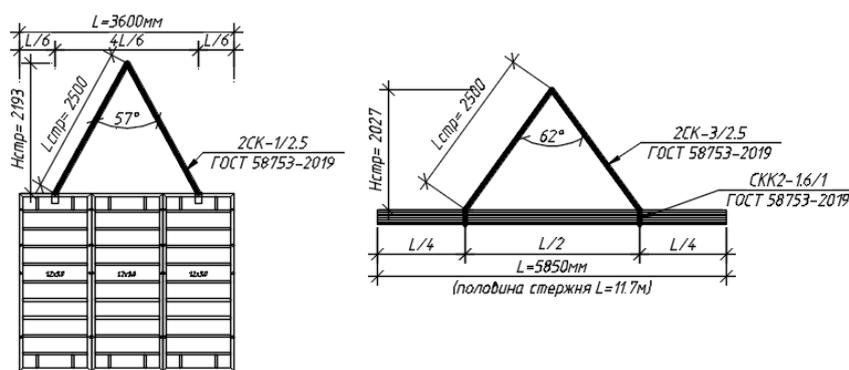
«Определение длины стропов для связки стержневой арматуры и карты опалубки» [27]
